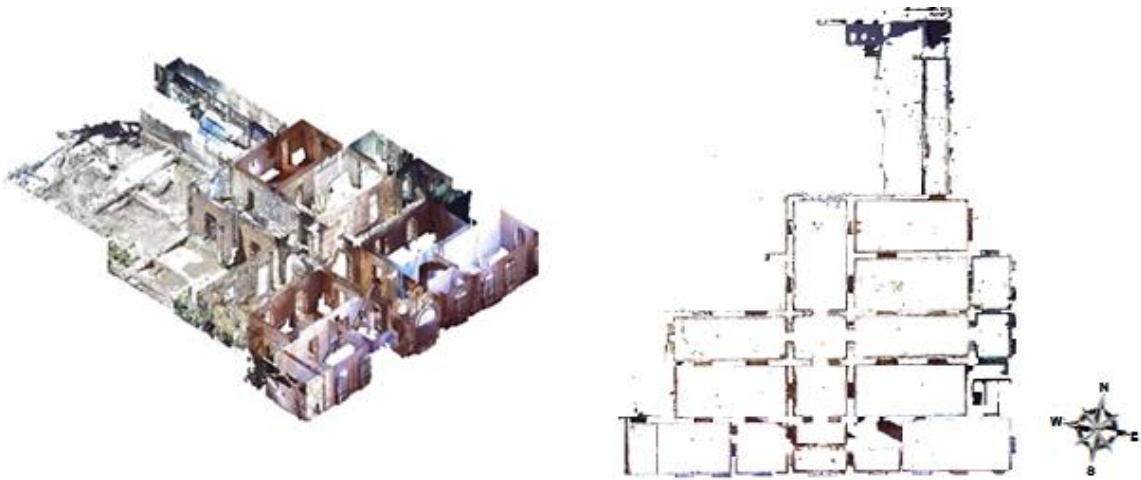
Reconstitución 3D del primer piso del Palacio Pereira y planta del primer piso.
